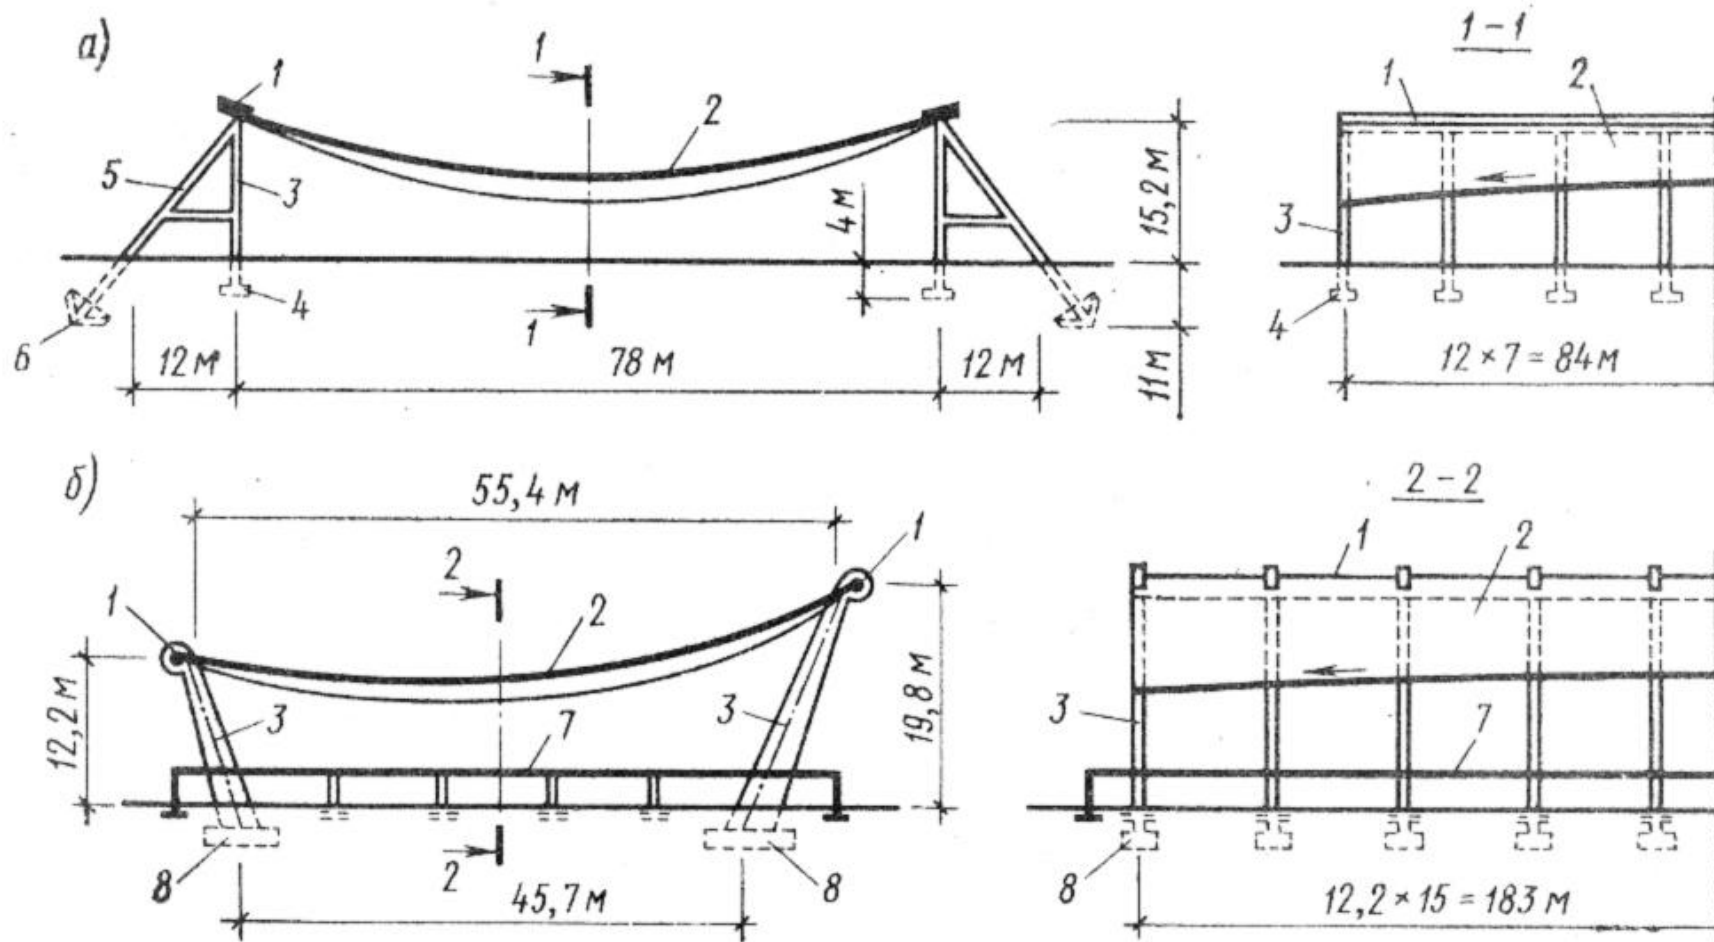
Висячие оболочки на прямоугольном плане:
